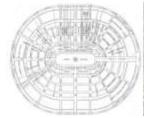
Le hall central (Palais du Champ de Mars), 1867 (Projektanti: inženjeri Pierre Guillaume Frédéric Le Play i Gustave Eiffel)
